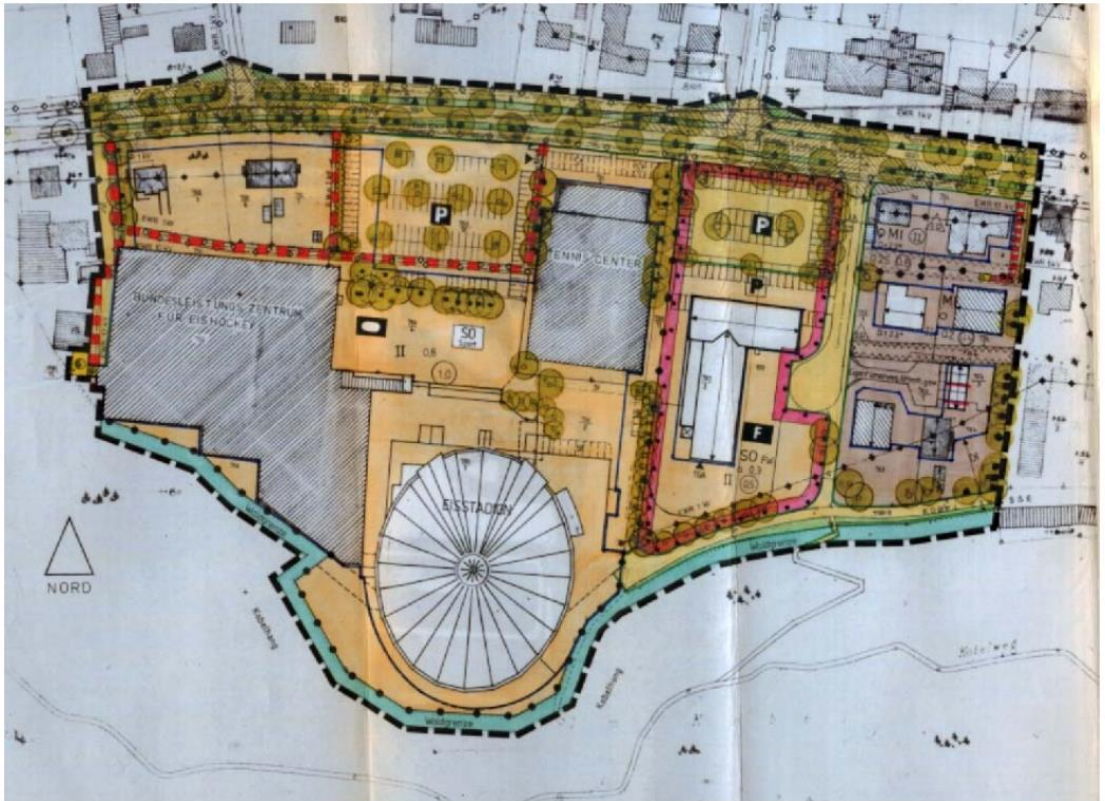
Bebauungsplan W 27 – Am Kobelhang
